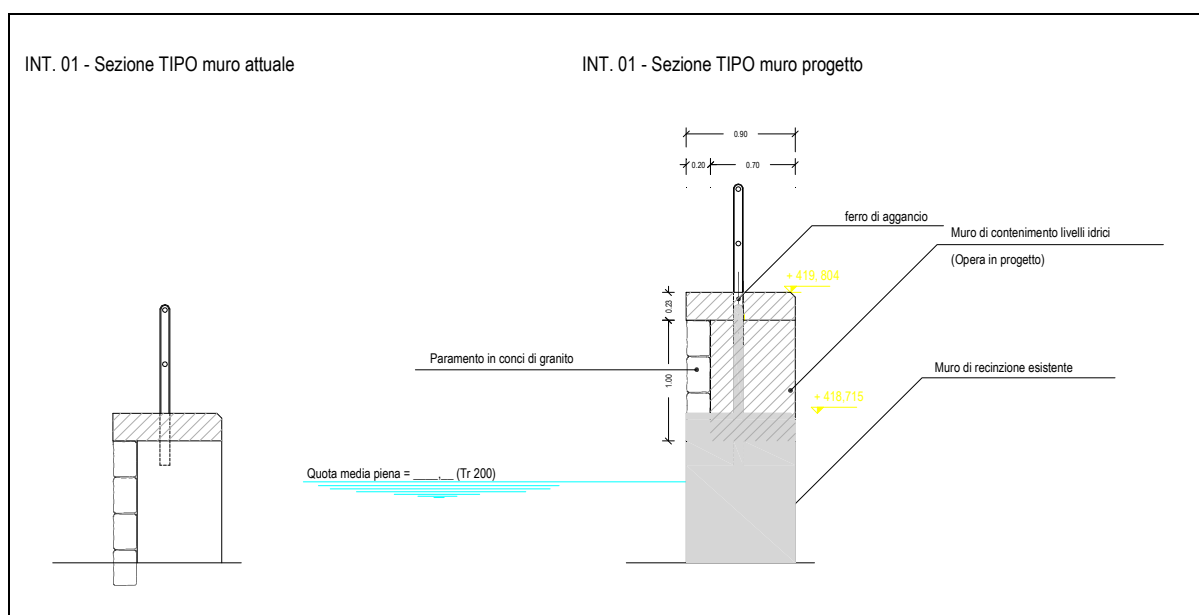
Sezione muro di sponda da riportare in quota a garanzia del franco idraulico(Sez. n. 45)
